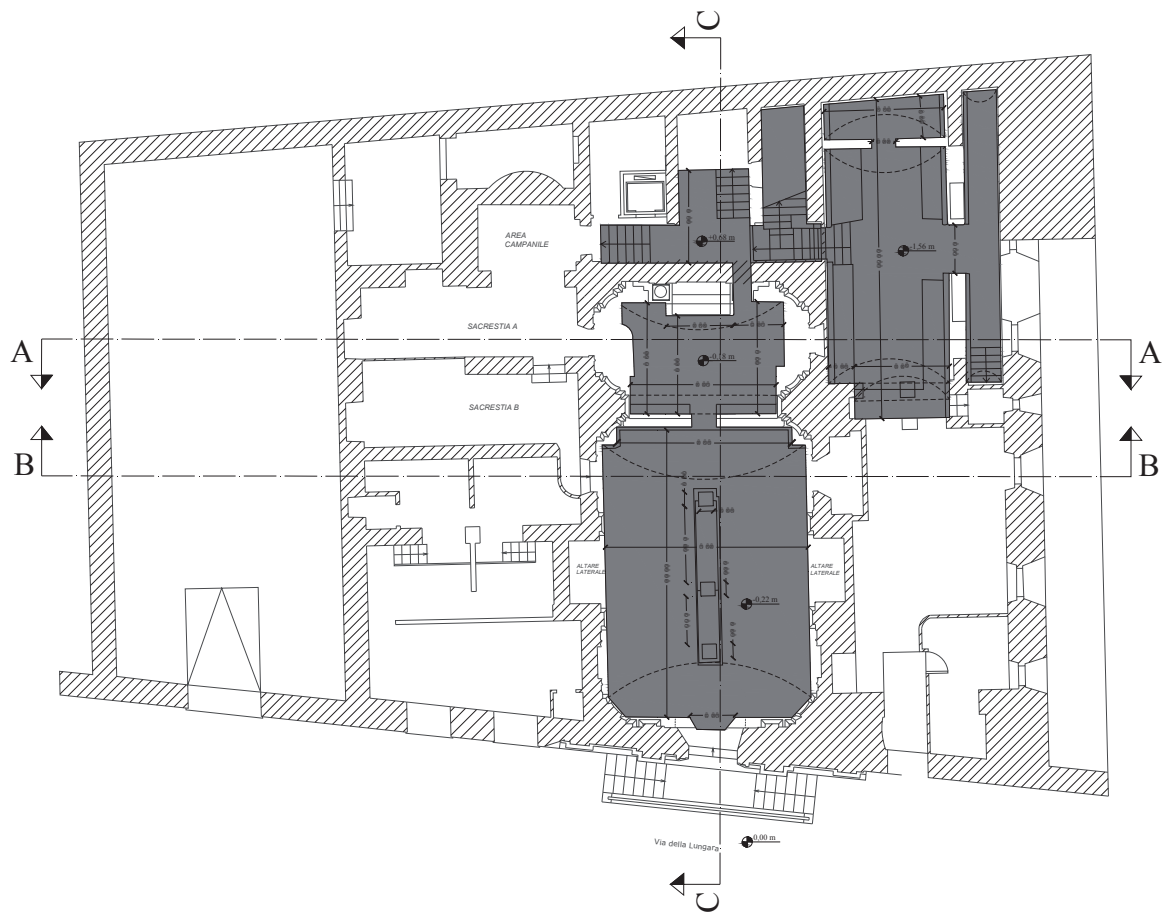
Sovrapposizione della pianta dei sotterranei con il piano terra, rialzato rispetto a via della Lungara. Le due volte sottostanti la Chiesa sono divise da un muro, quasi in corrispondenza dell'arco trionfale.
